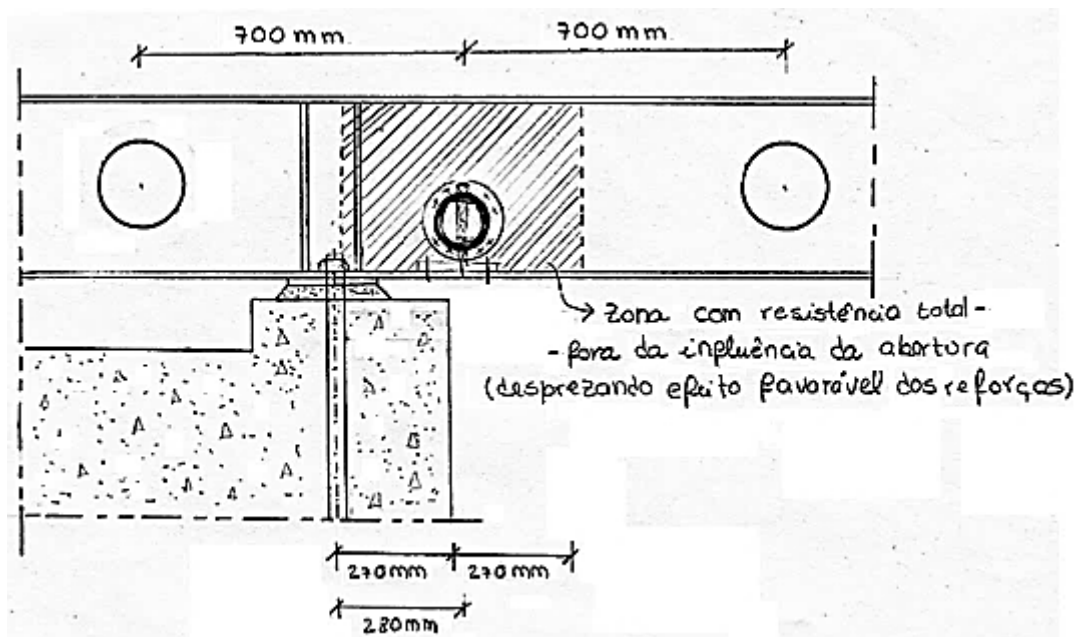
Pormenor construtivo de uma viga metálica sobre uma chapa de base e apoiada num elemento de betão armado, adaptado de (Cima Gomes; Biscaia, N., 2008)
